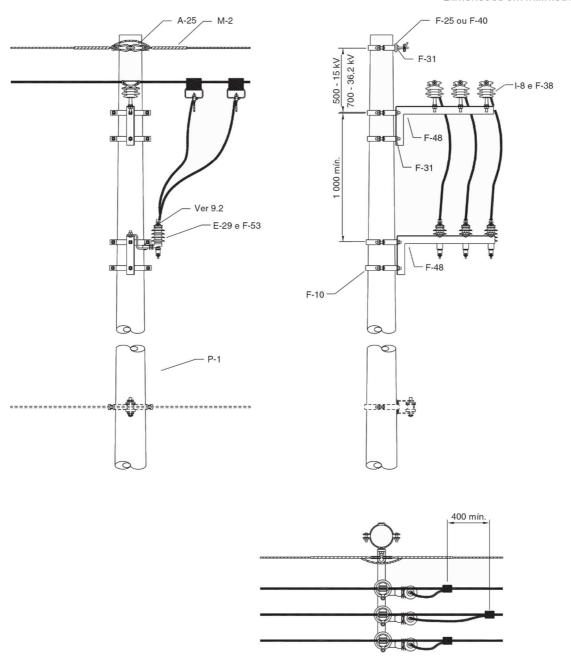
Estrutura CE2 PR – Poste de concreto de seção circular
